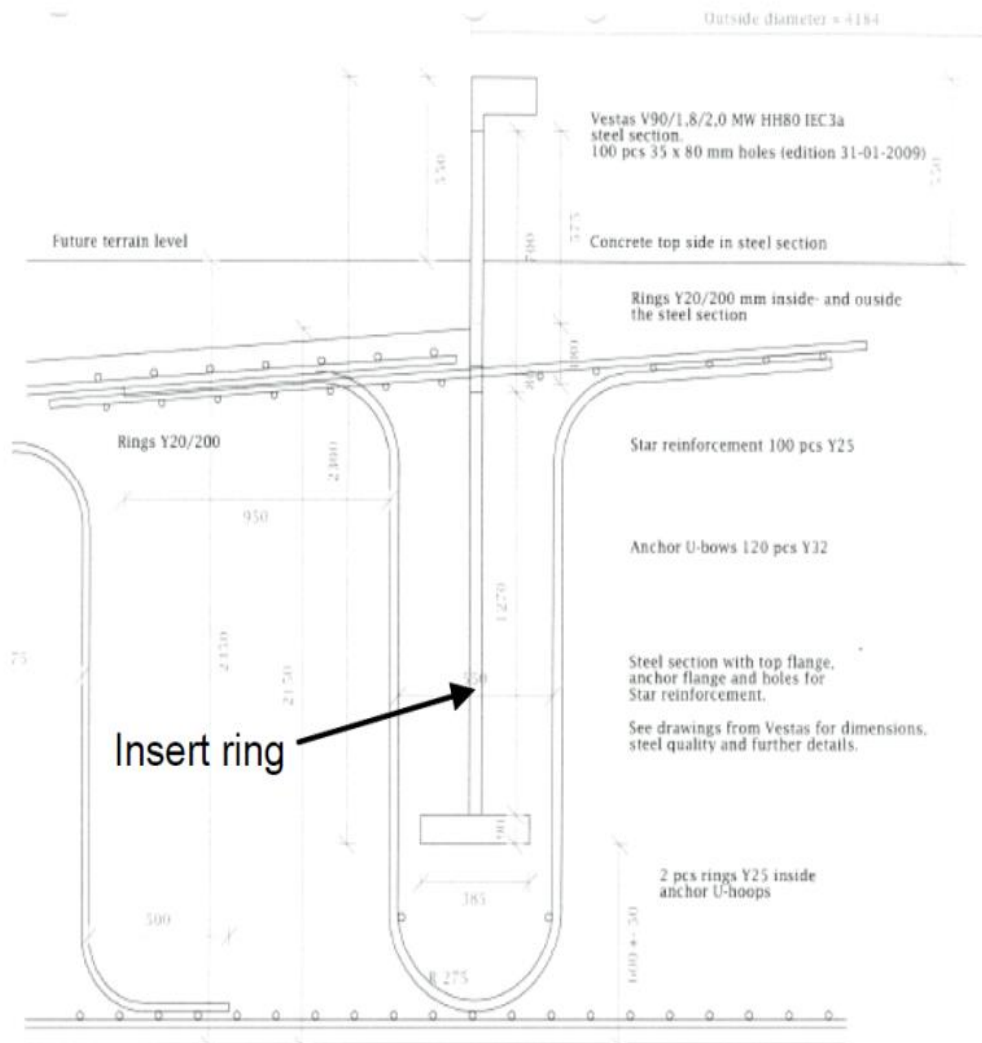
Vista da ligação em anel de aço em corte. Fonte: [40]
